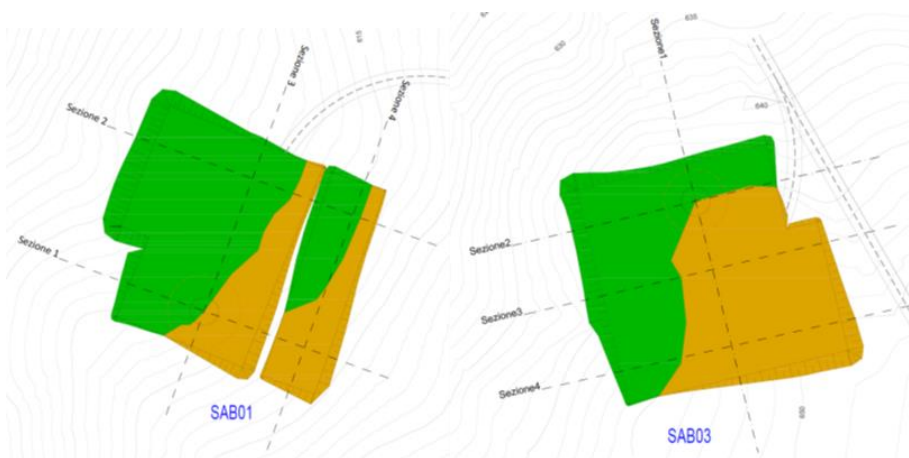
Planimetria Fase di Costruzione SAB01 e SAB03
